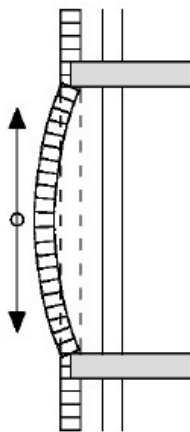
Відшарування облицювання кладки, що не перев'язана з основною кладкою стіни
